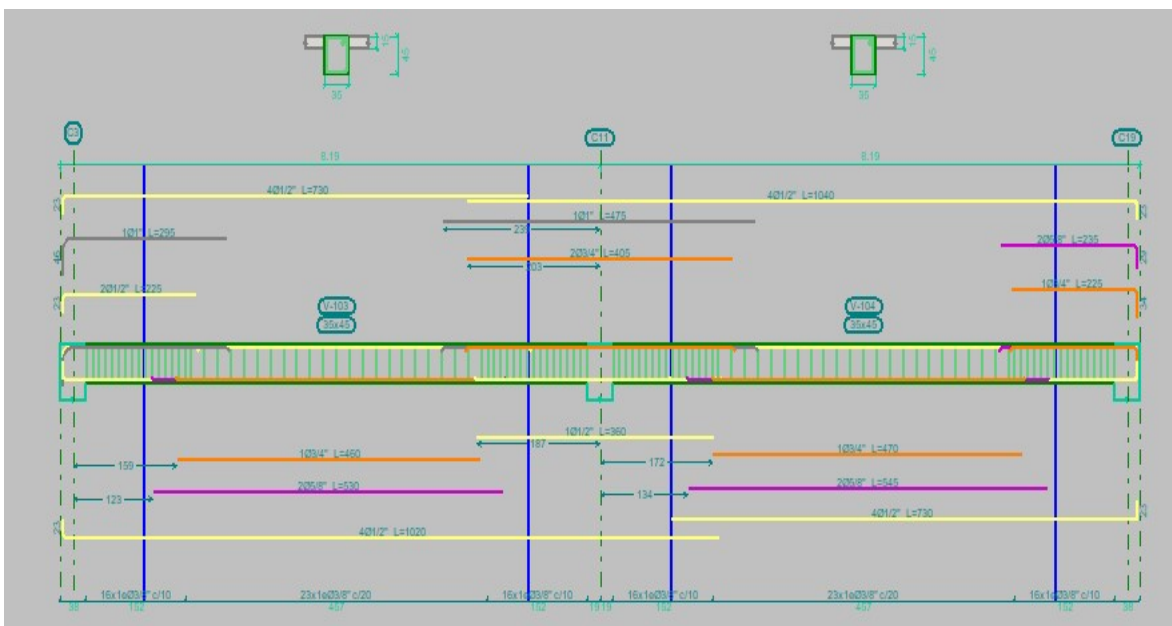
Planos vigas de refuerzo: Elaboración propia.
